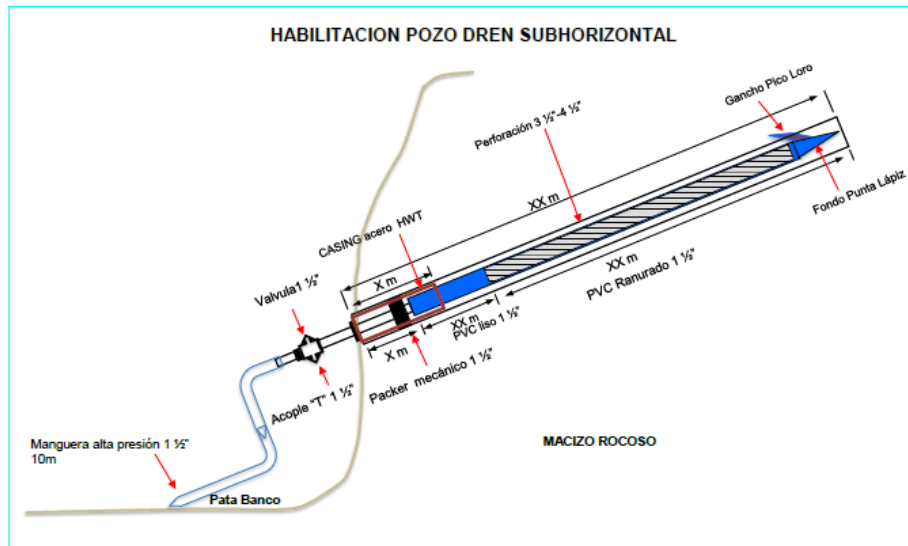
Perforación Dren Subhorizontal y habilitación (Fuente: Derk, 2016).
